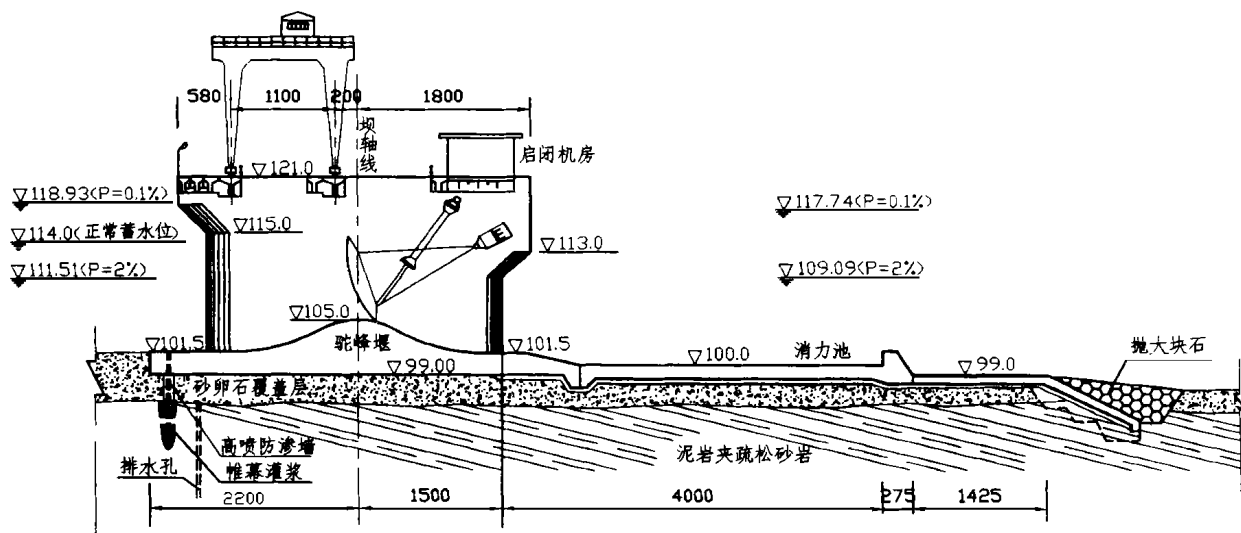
驼峰堰方案闸坝剖面图 (单位:高程 m,其余 cm)
